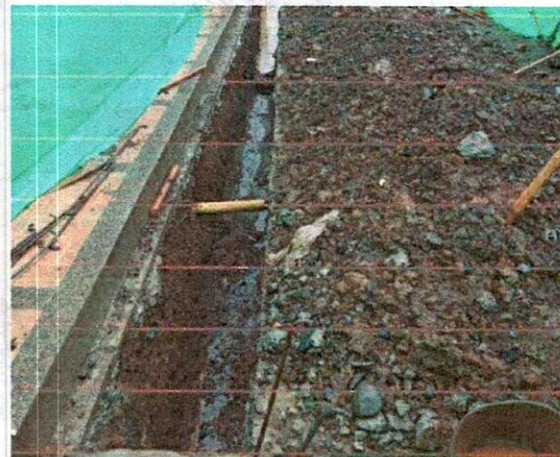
y 6: Viguetas de ensayo y vibrado de concreto en calle 7 entre carreras 5 y 6.
